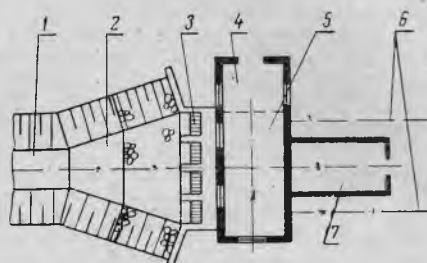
Схема размещения пристройки электрораспределительных устройств в середине здания насосной станции:
